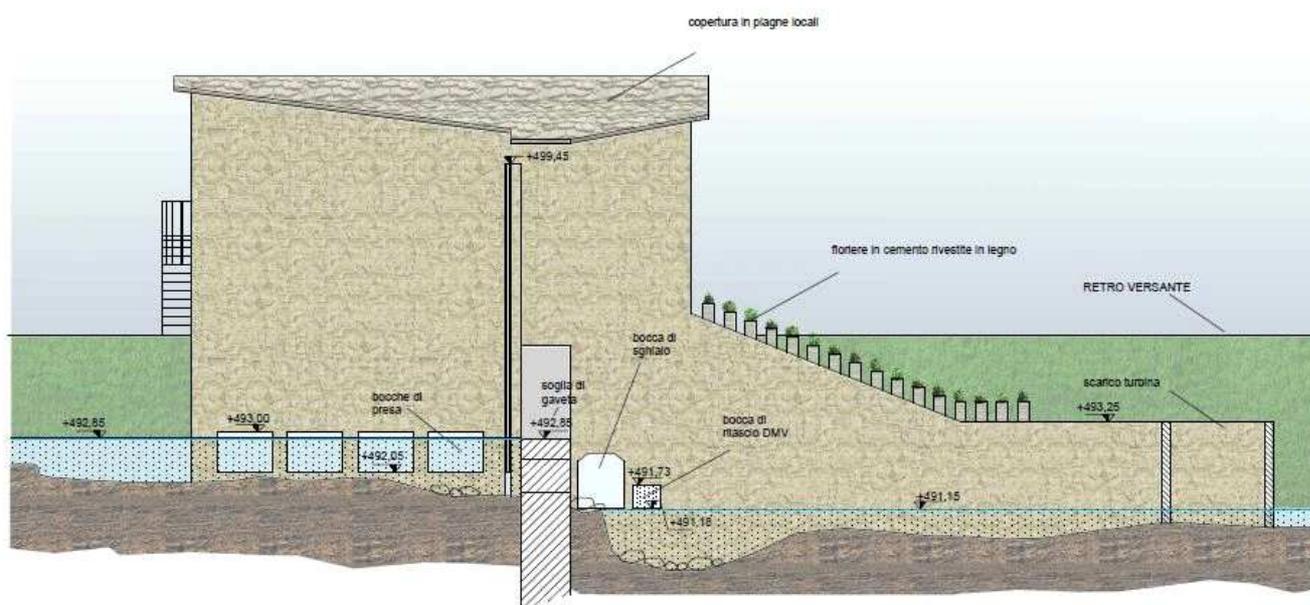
Vista da fiume_ Estratto Elaborato 016 Piante, sezioni e prospetti della centralina
